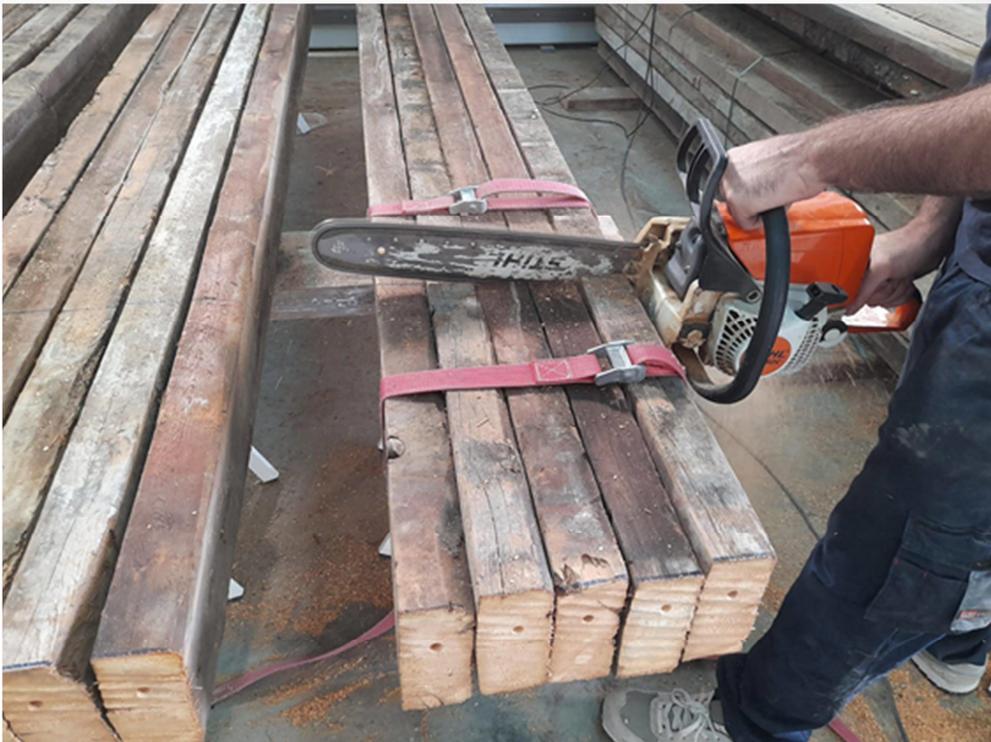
Corte con motosierra de las viguetas para simular zonas deterioradas eliminadas como paso previo a la reparación.
